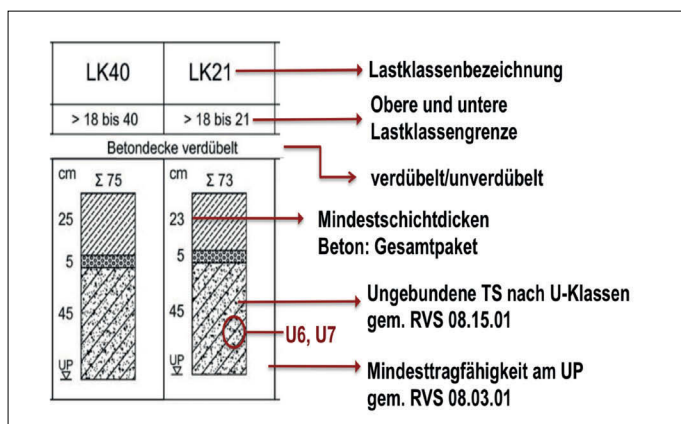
Aufbau Bemessungskatalog Betonstraßen
